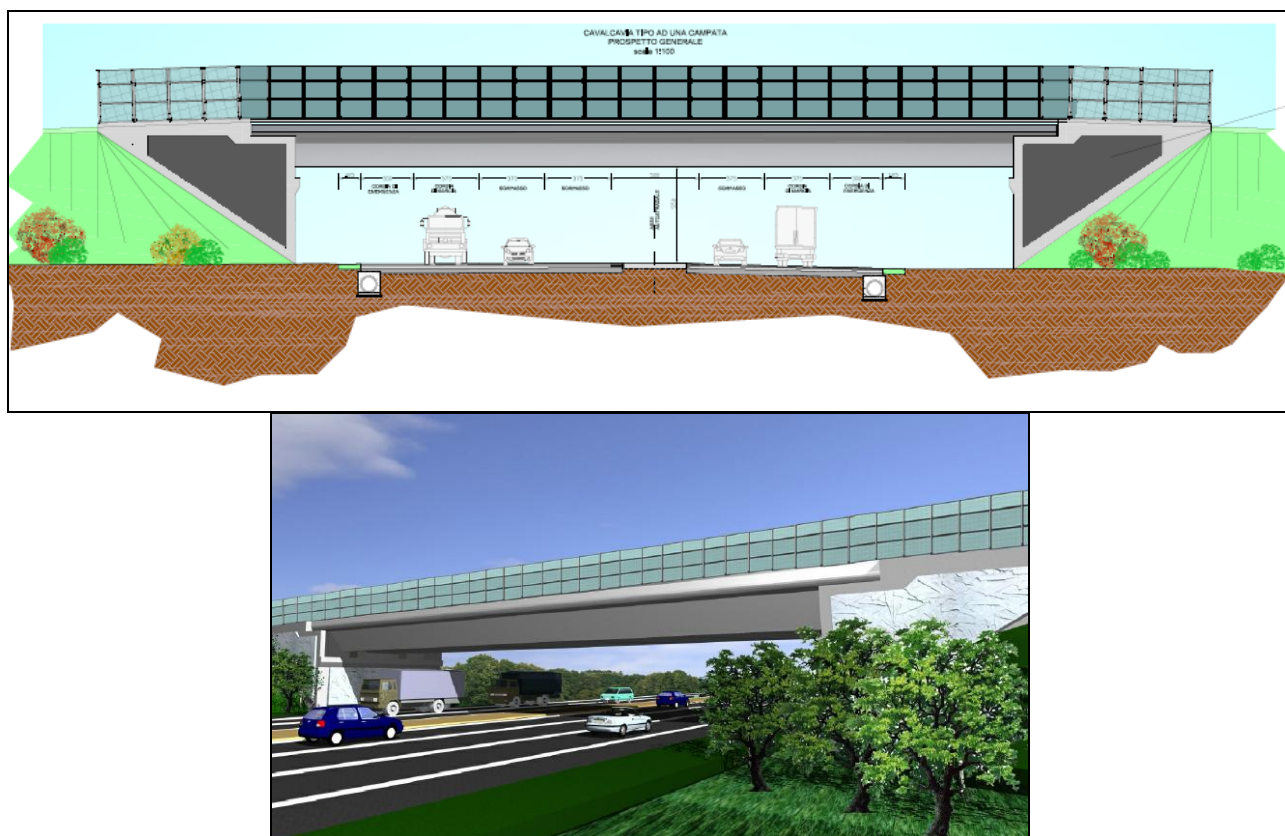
/1 Prospetto tipologico e vista prospettica dei cavalcavia in progetto
